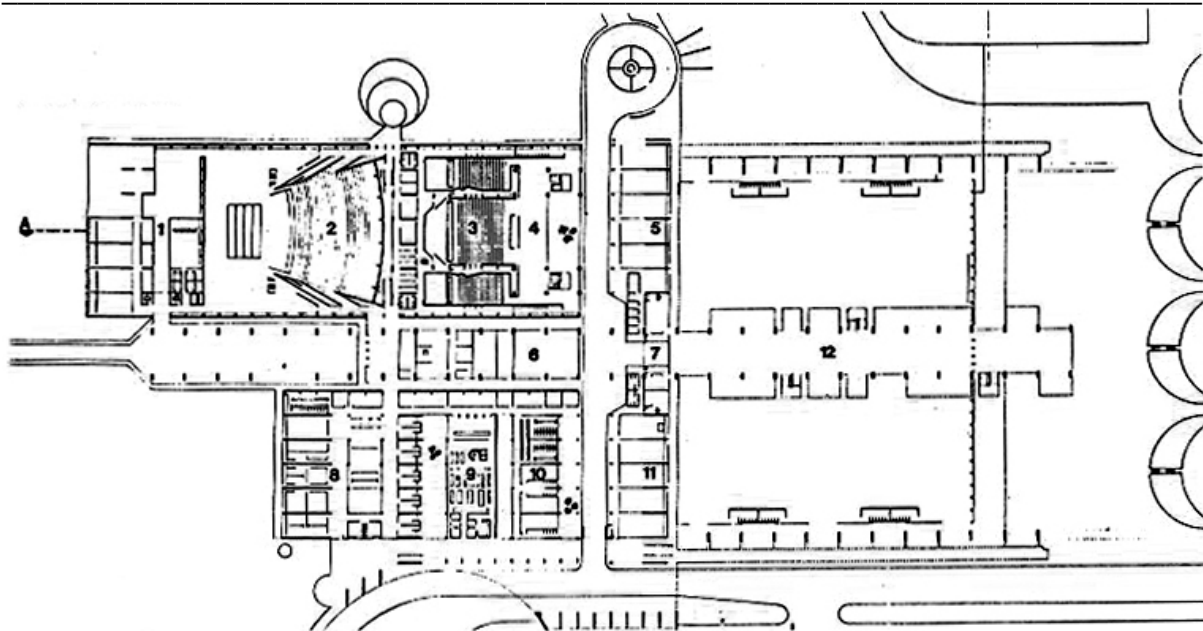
planta pavimento térreo: 1) camarins e apoio de palco; 2) Teatro Guararapes (2.400 lugares); 3) auditório Brum; 4) saguão; 5) depósitos; 7) acesso ao pavilhão de feiras; 8) setor administrativo; 9) restaurante; 10) salas de convenções; 11) depósitos; 12) circulação;
